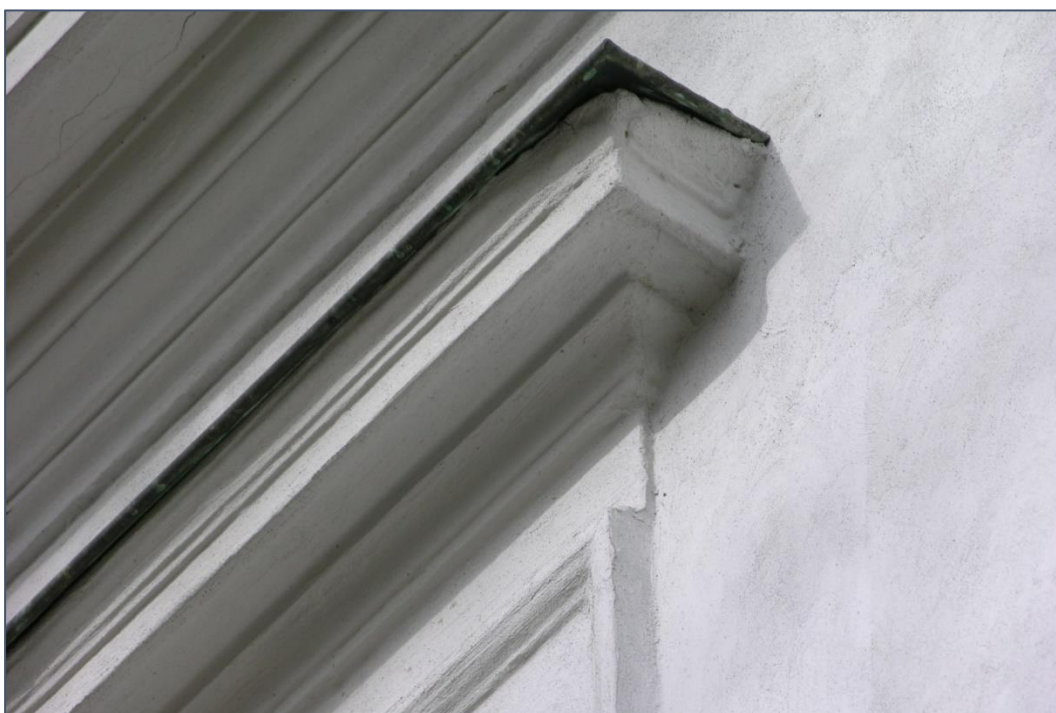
Dawna Oberża, elewacja południowa – widok szczegółowy pęknięcia na nadprożu okiennym
